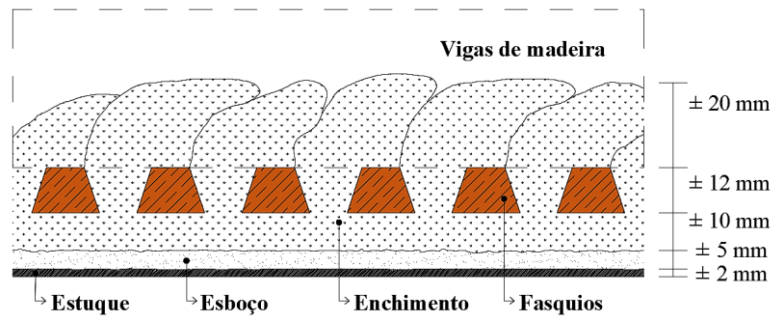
Tecto de ripado trapezoidal de madeira - corte transversal
